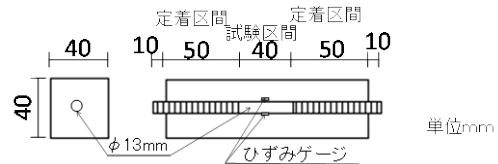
乾燥収縮ひび割れ試験体概要 (シリーズ I)
